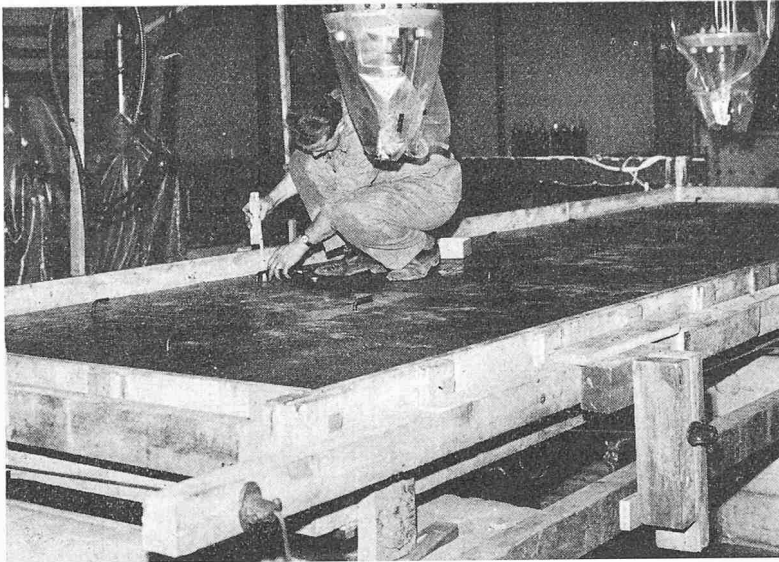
Einsetzen der Haftanker in die Konstruktionsbetonplatte unmittelbar vor dem Einbau des Deckbelages
